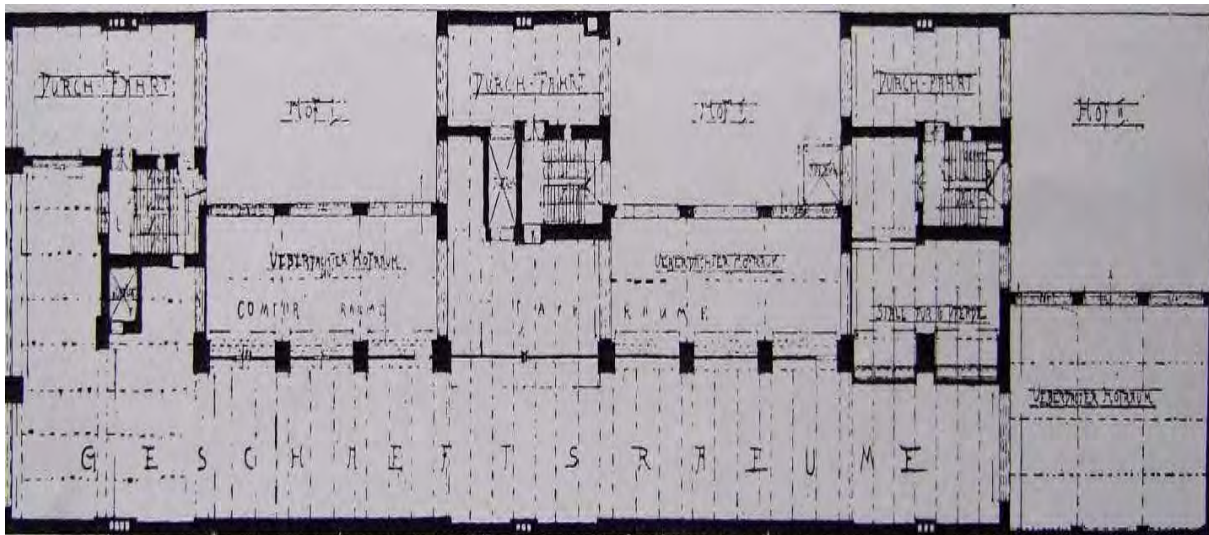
Grundriss von A. S. Ball, Potsdamerstr. 27a.
